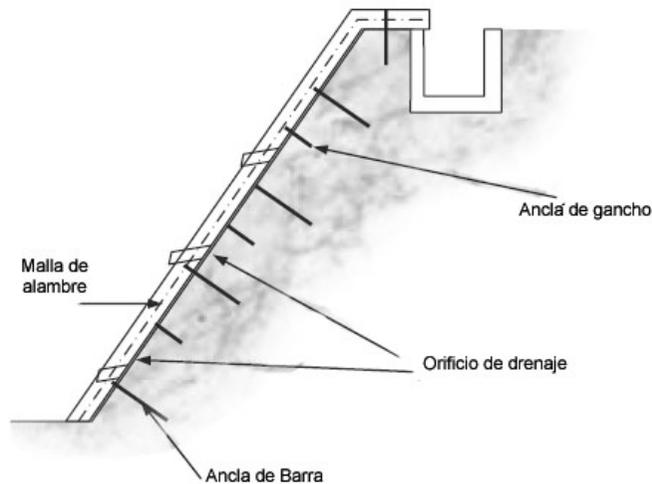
Ejemplo Típico de Mortero Proyectado (Shotcrete)
